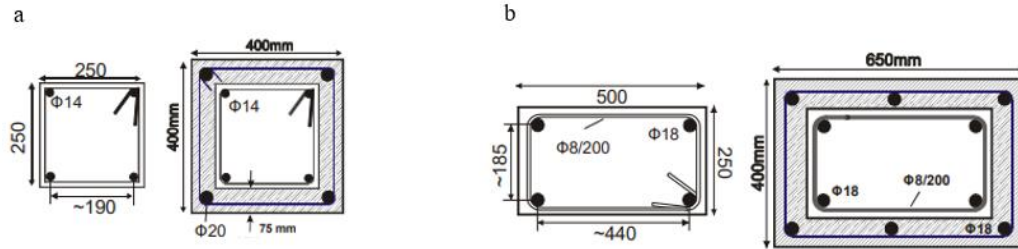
Sección transversal de las columnas ensayadas de Bousias et al. (2004): a) serie 1, b) serie 2
